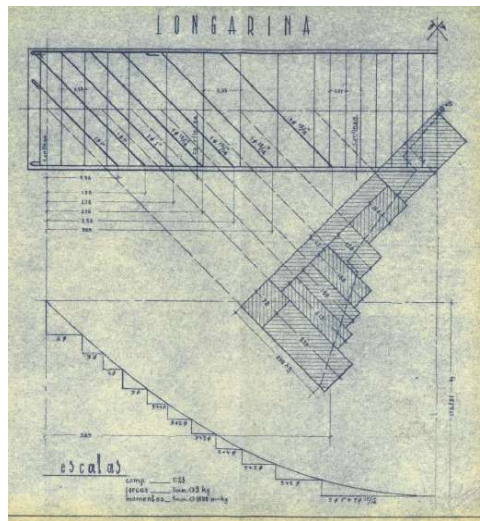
Pormenor das armaduras das vigas longitudinais (M. Públicas, 1951).
